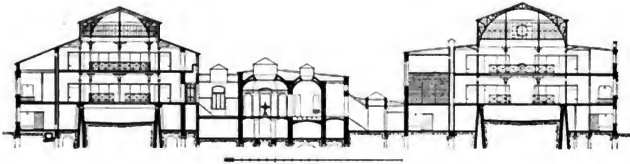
Längsschnitt durch das Badeanstaltsgebäude.
